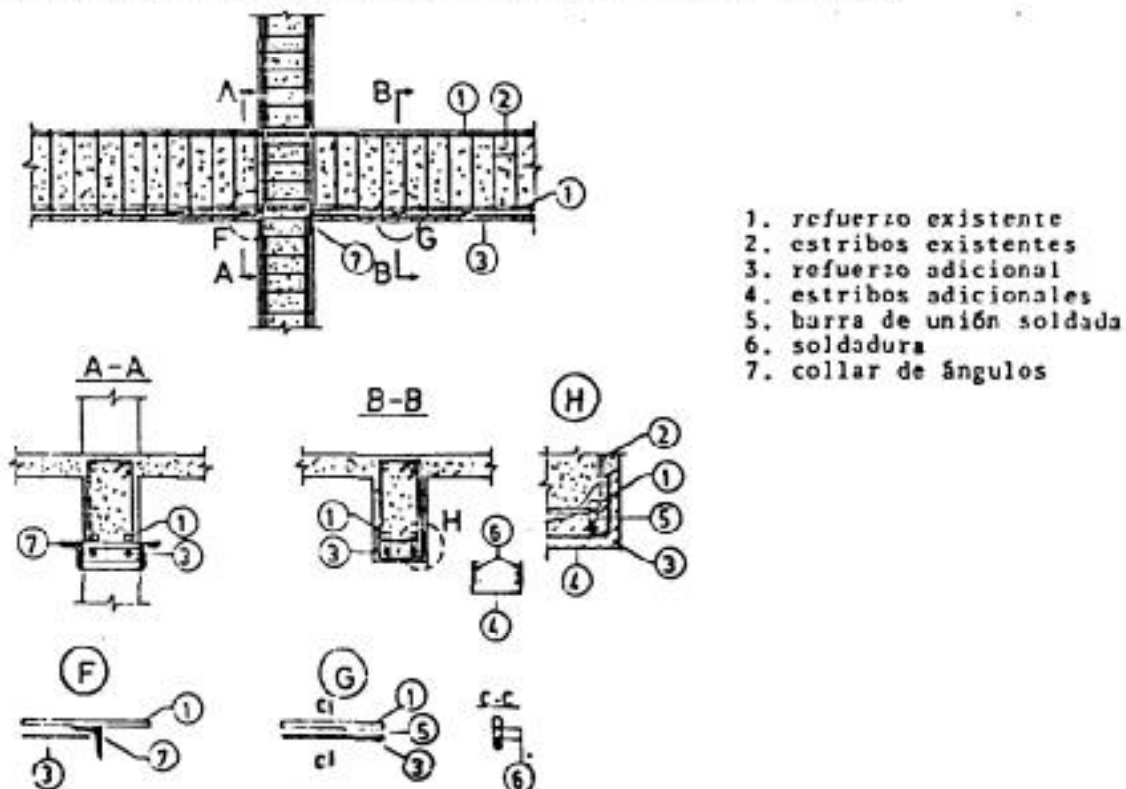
Encamisado con concreto reforzado por flexión (ref. 1)
